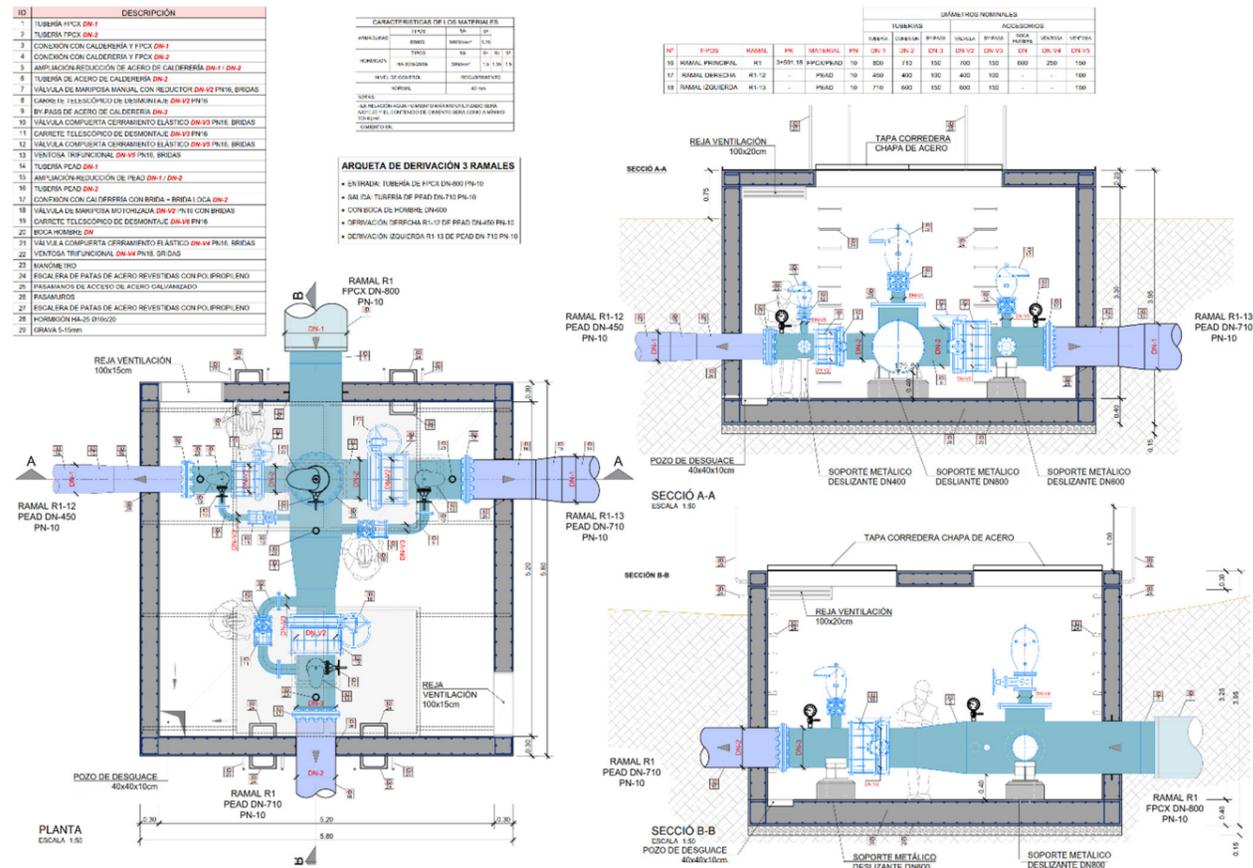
Seccionamiento nº 3 y seccionamientos nº 8-9-10, 11-12-13 y 16-17-18 de tipo ATFP. Diferentes PQ del ramal R1.
